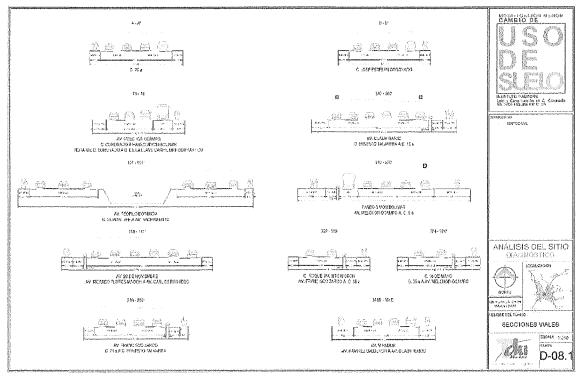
Plano de Secciones Viales en la zona de estudio. Fuente: Elaboración propia. Ver Plano D-08.1 Secciones Viales.
